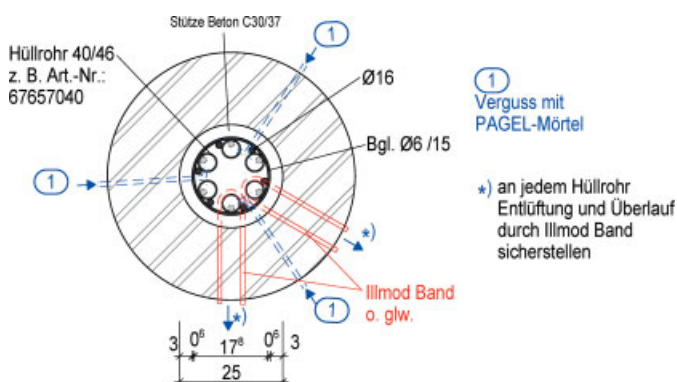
Stützenstoß einer mit Betonkern ertüchtigten Stütze, Grundriss
